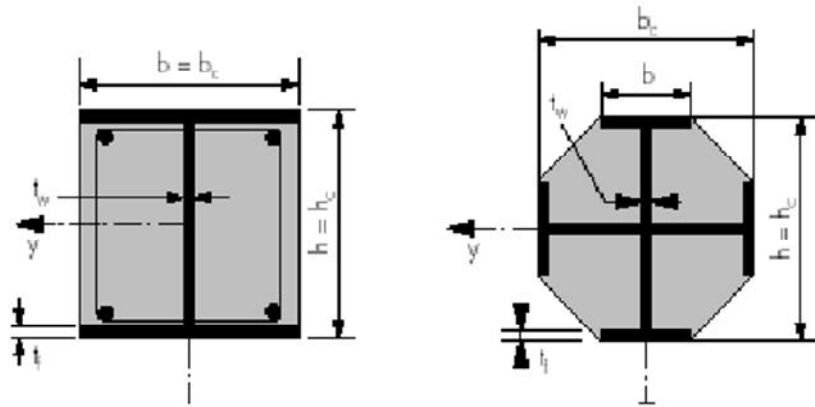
Exemples de poteaux mixtes partiellement enrobés
